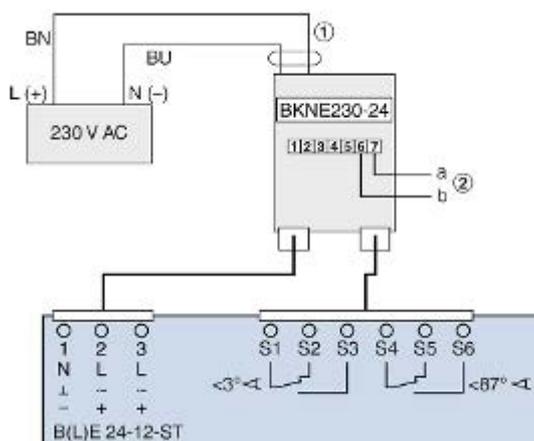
Exemplo de cablagem para o acessório B24BKNE
